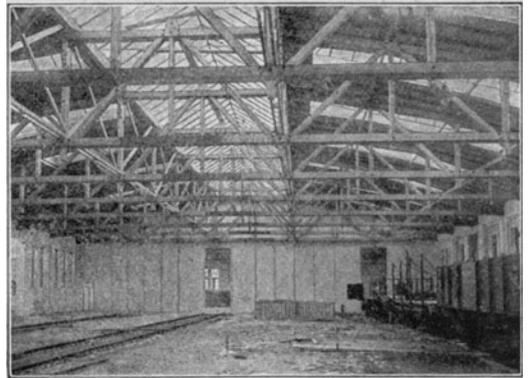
Montagehalle Niesky O/L. Fachwerksbinderkonstruktion, mit Stoßrippe ausgeführt 1919.
